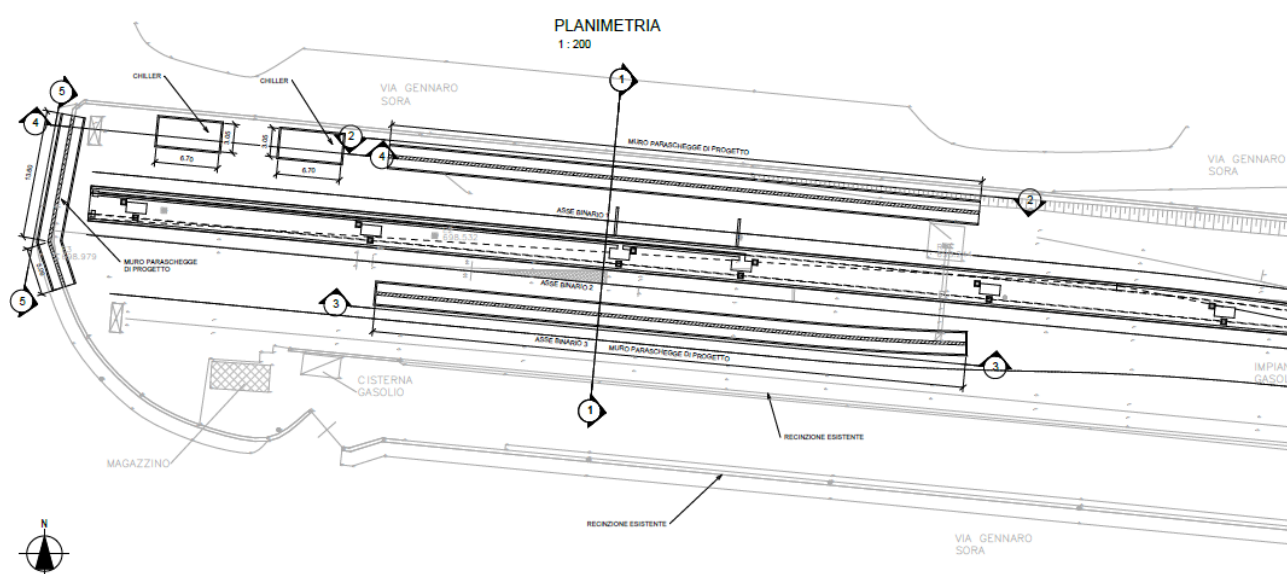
Planimetria di progetto- Stazione di Edolo (BS)
